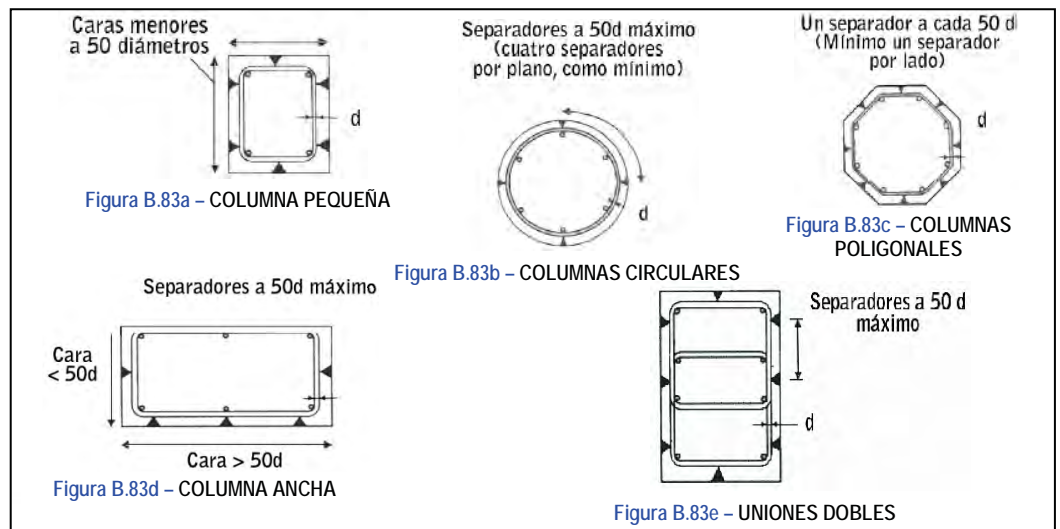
DISPOSICIÓN DE SEPARADORES EN COLUMNAS EN SENTIDO TRANSVERSAL
